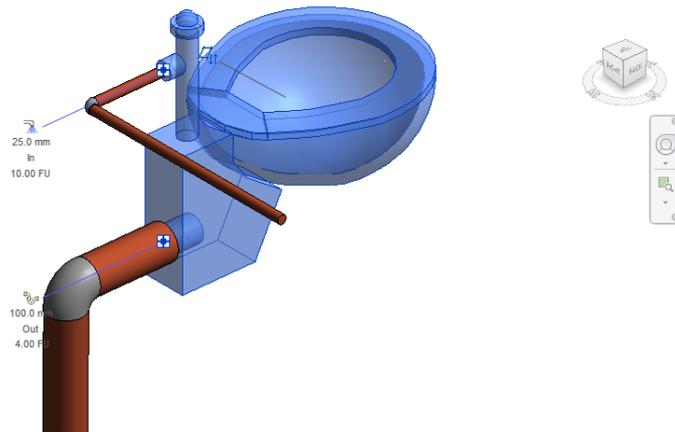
Pormenor da conexão entre bacia de retrete e tubagem.
